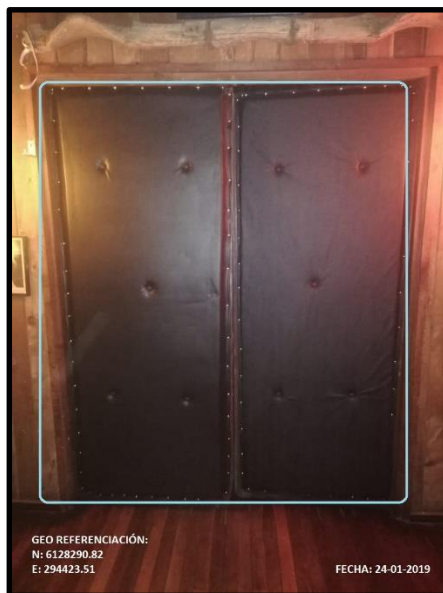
“Puerta Hall – Sala de Baile Después de ser Intervenido”.
